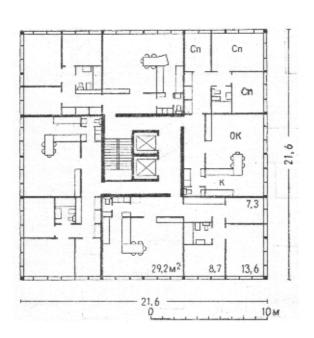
План 12-этажного односекционного дома с четырьмя квартирами на этаже (Польша) Жилая площадь квартиры $58,8~\text{M}^2$
